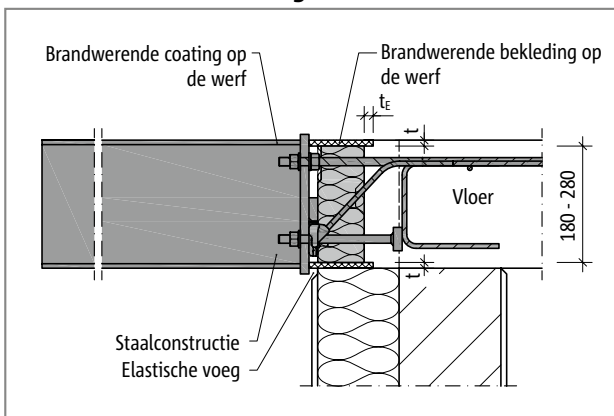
Schöck Isokorb® T type SK-MM2-VV1: Doorsnede
